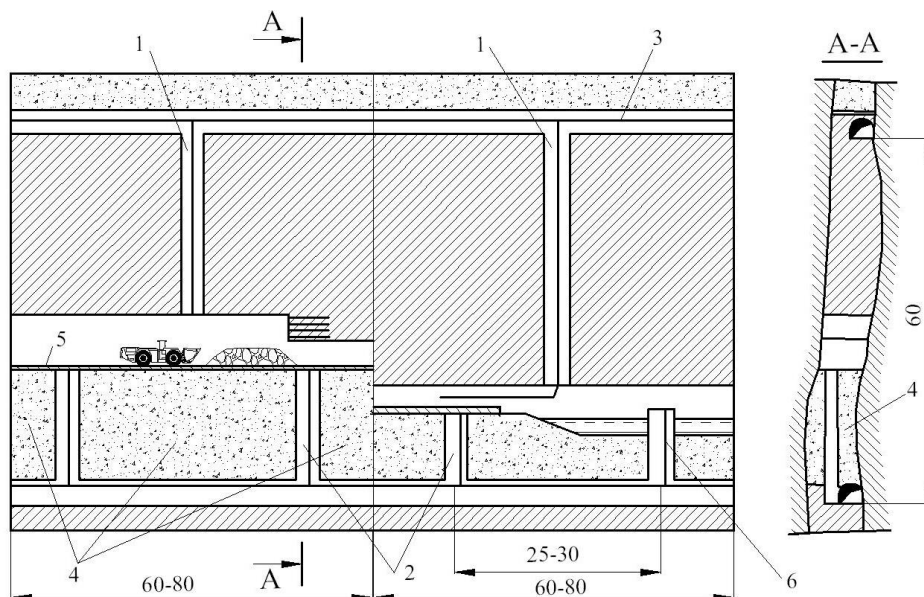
Система разработки горизонтальными слоями с гидрозакладкой и бетонным настилом. 1 – блоковые восстающие; 2 – рудоспуски и ходовые восстающие в два отделения; 3 – пульповод; 4 – гидрозакладка; 5 – бетонный настил; 6 – дренажная труба.
